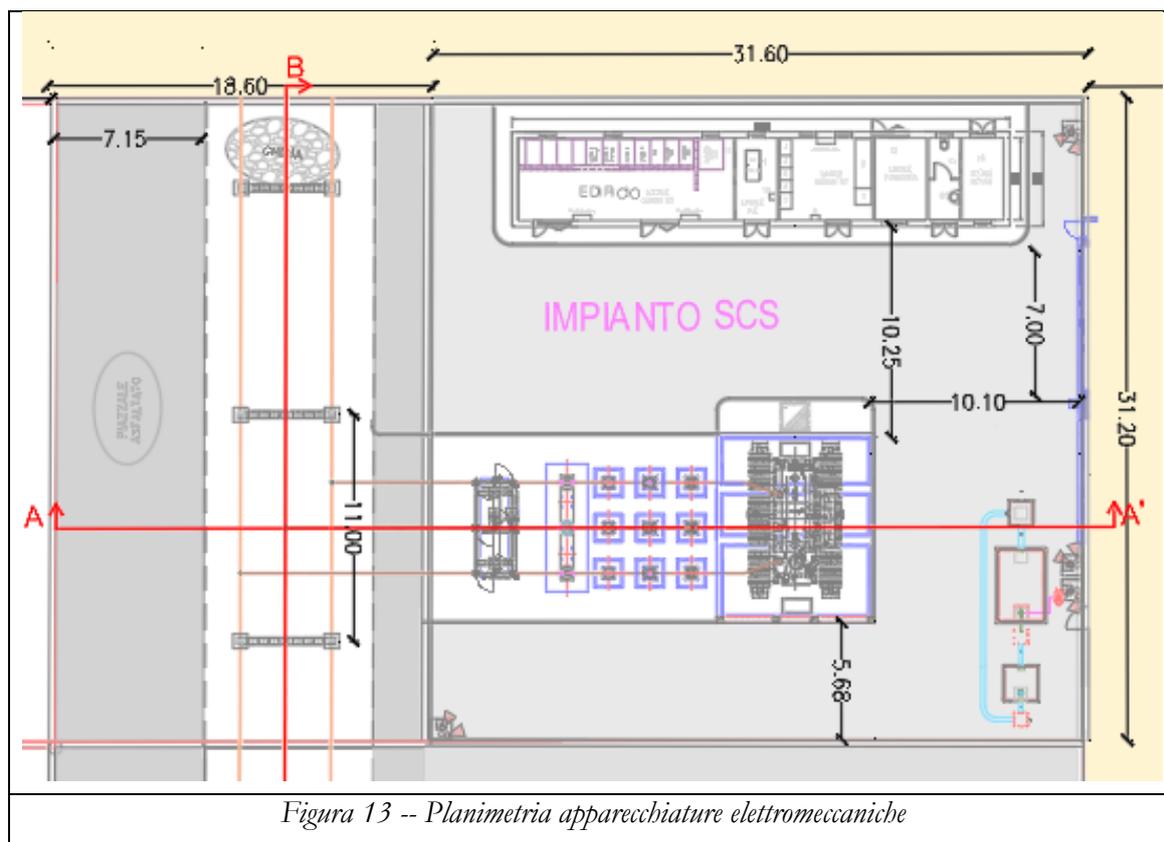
Planimetria apparecchiature elettromeccaniche
